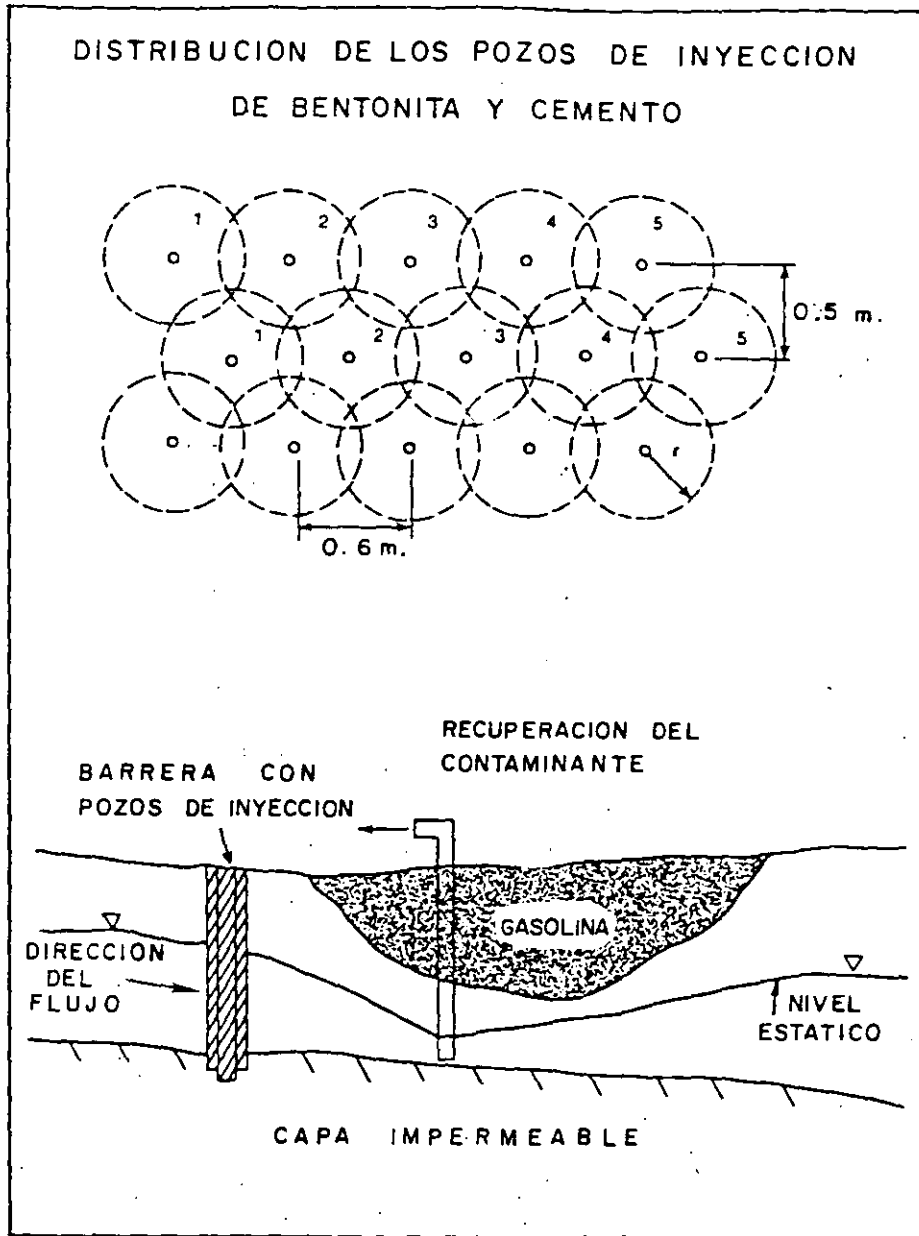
BARRERA PARA AISLAMIENTO DE ZONAS CONTAMINADAS
